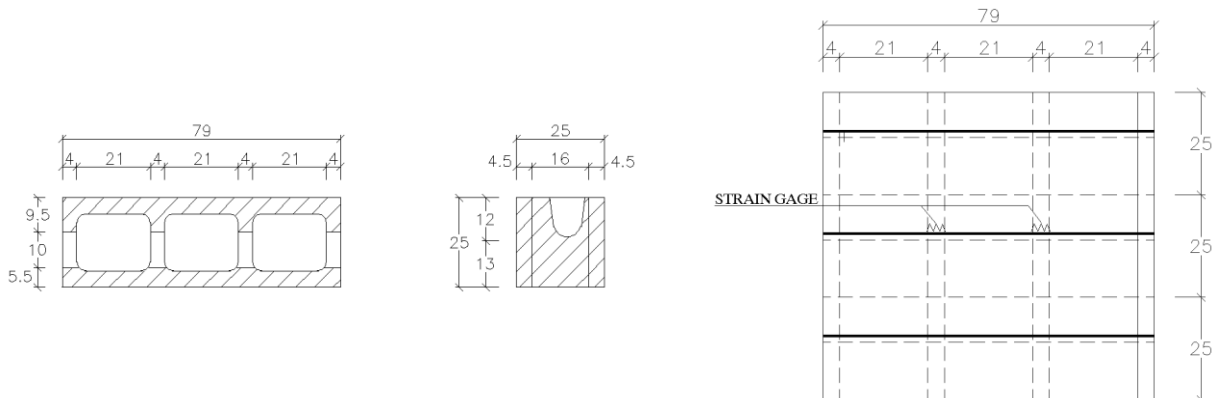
Sezioni e prospetto del provino N25 ϕ 8 2SG
